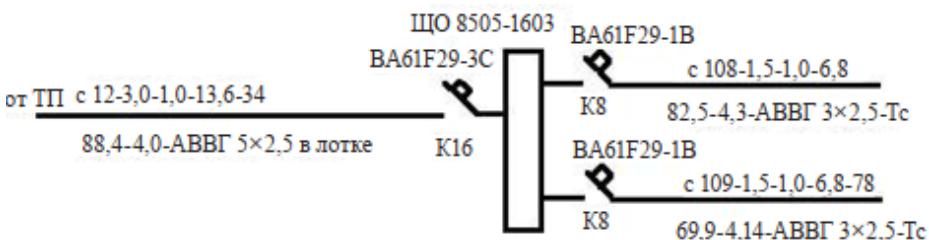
Пример оформления надписей на расчётной схеме осветительной сети
